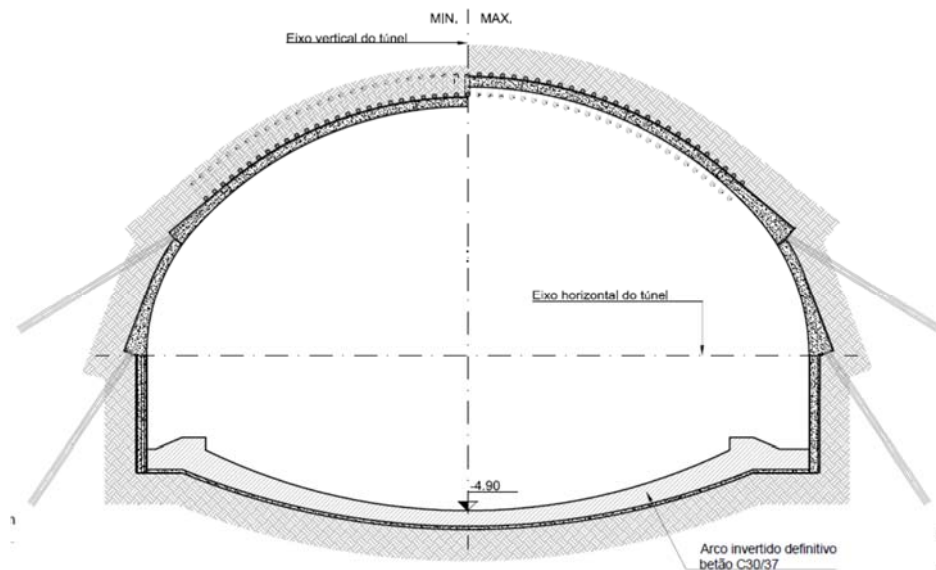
Seção tipo da fase 4 – rebaixo – arco invertido em ZG3
